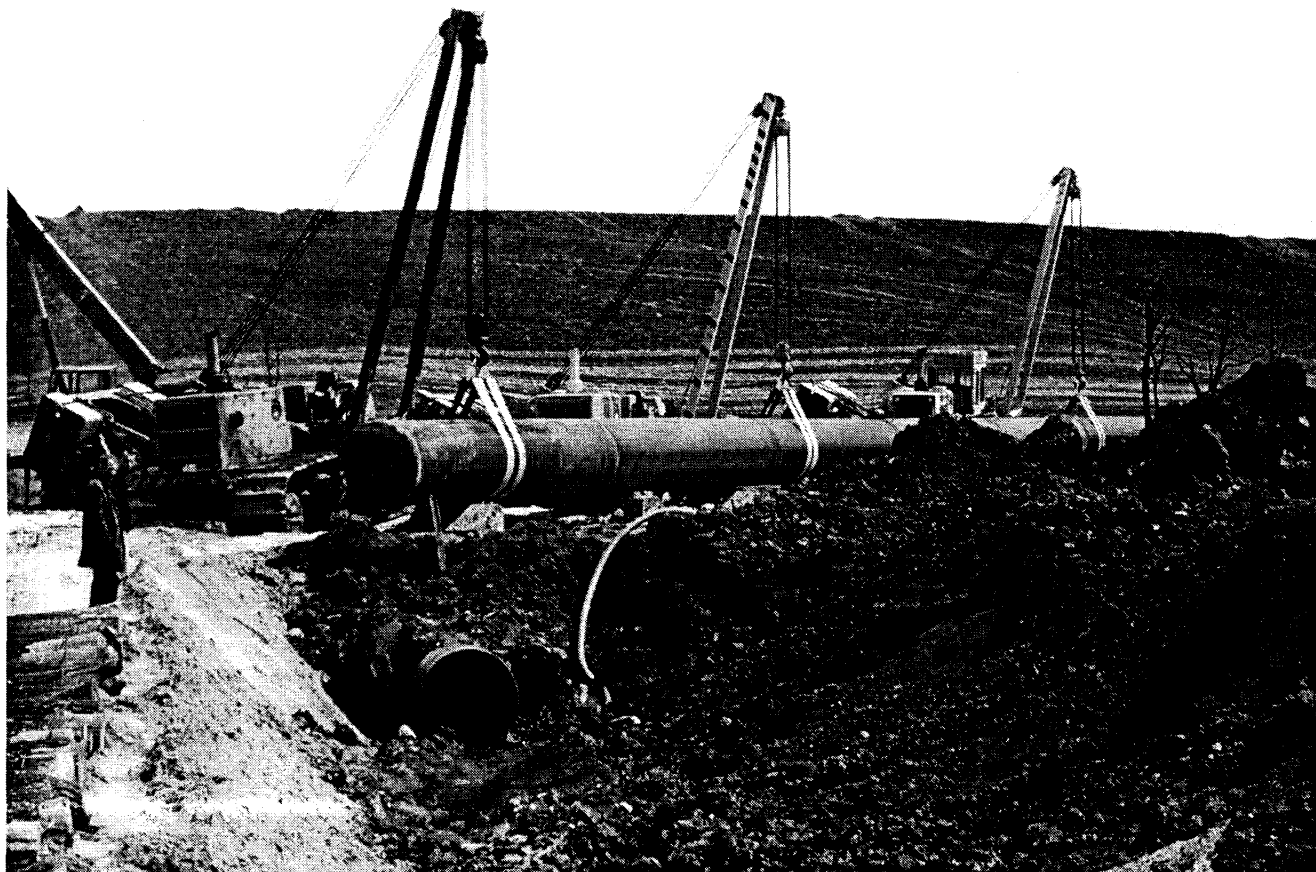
Ділянка трубопроводу, на якій проводяться будівельно-монтажні роботи
